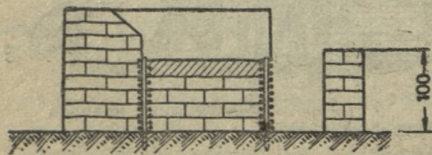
Открытая миномётная площадка с укрытием из грунтоблоков (для 50-мм миномёта)
